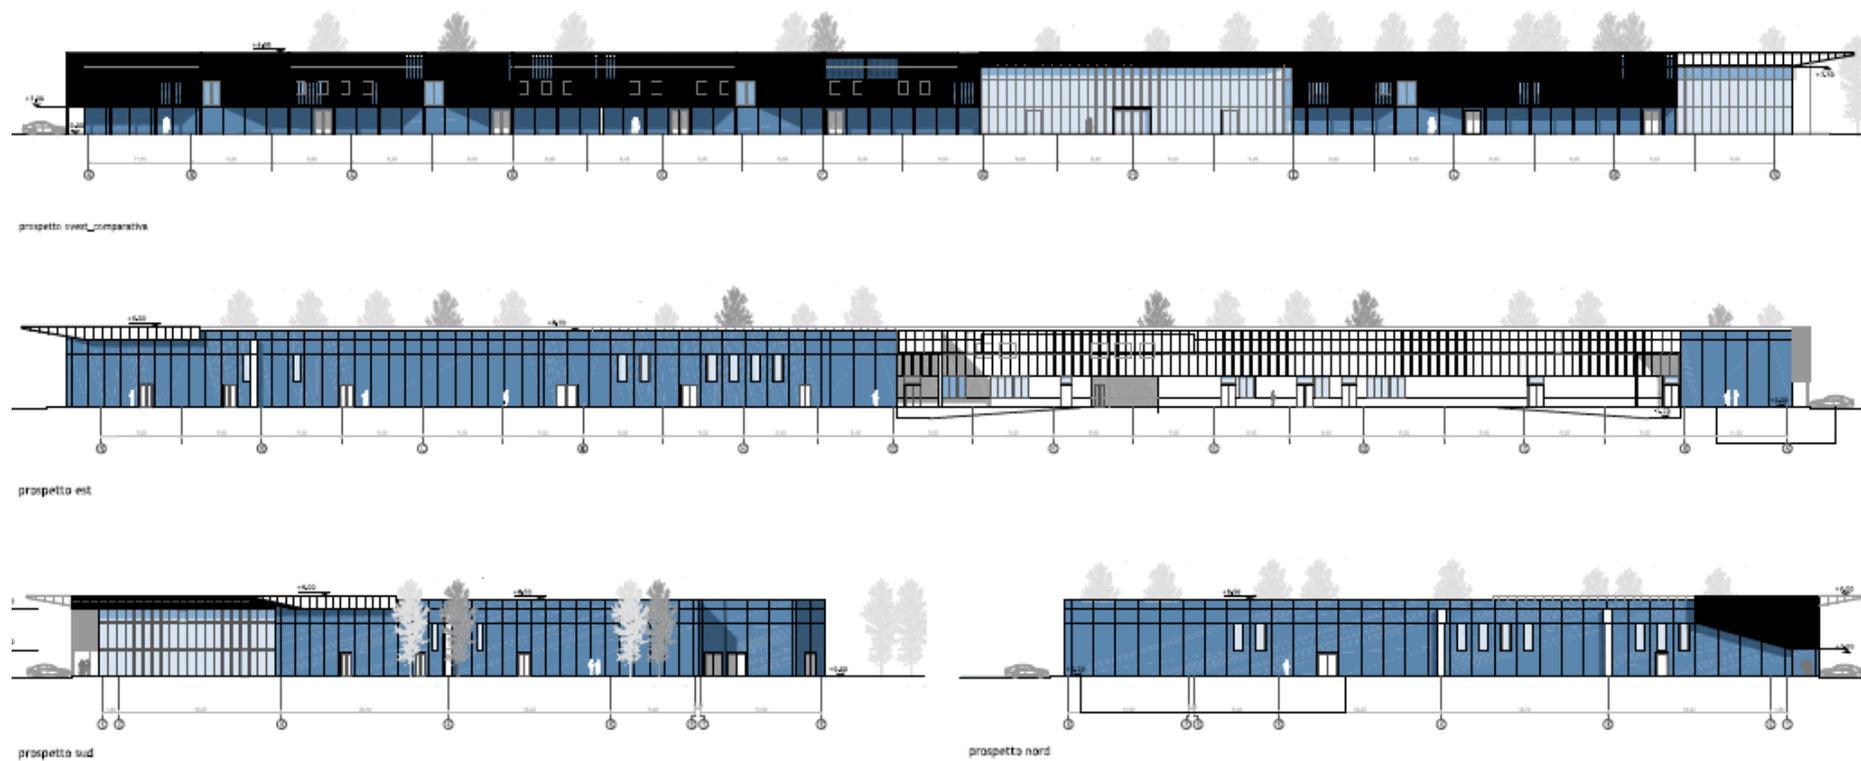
Progetto definitivo - prospetti e sezioni (FONTE: elaborati Ing. Endrizzi)
